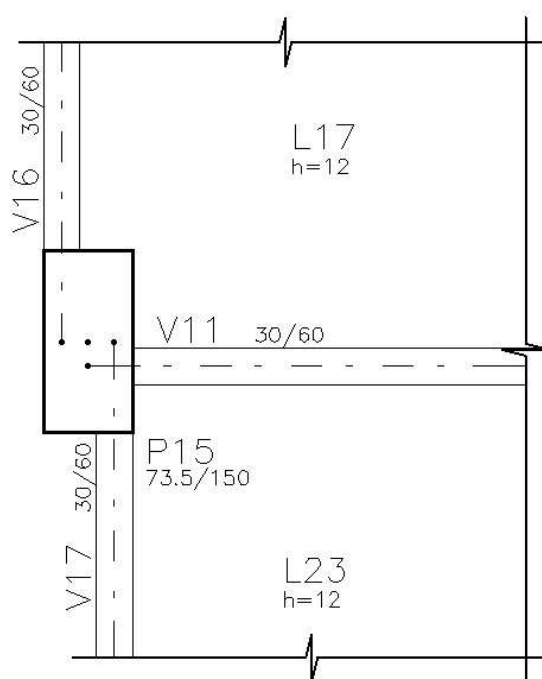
Ligação pilares e vigas com *body constraint* (MPC)
